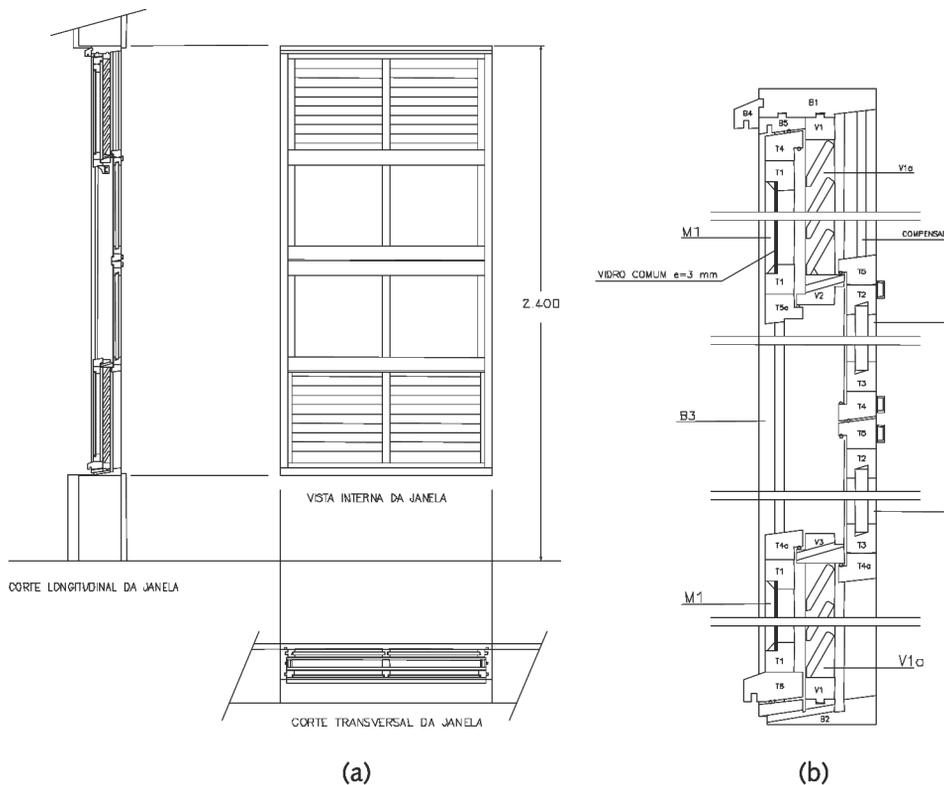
Janela de correr veneziana vertical: a) elevação frontal e cortes longitudinal e transversal da janela; b) corte longitudinal em detalhe
